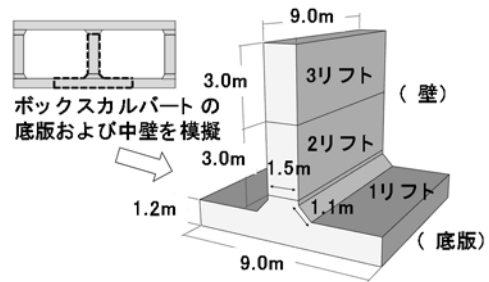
試験体の概要 (Outline of Wall-like Structure)
